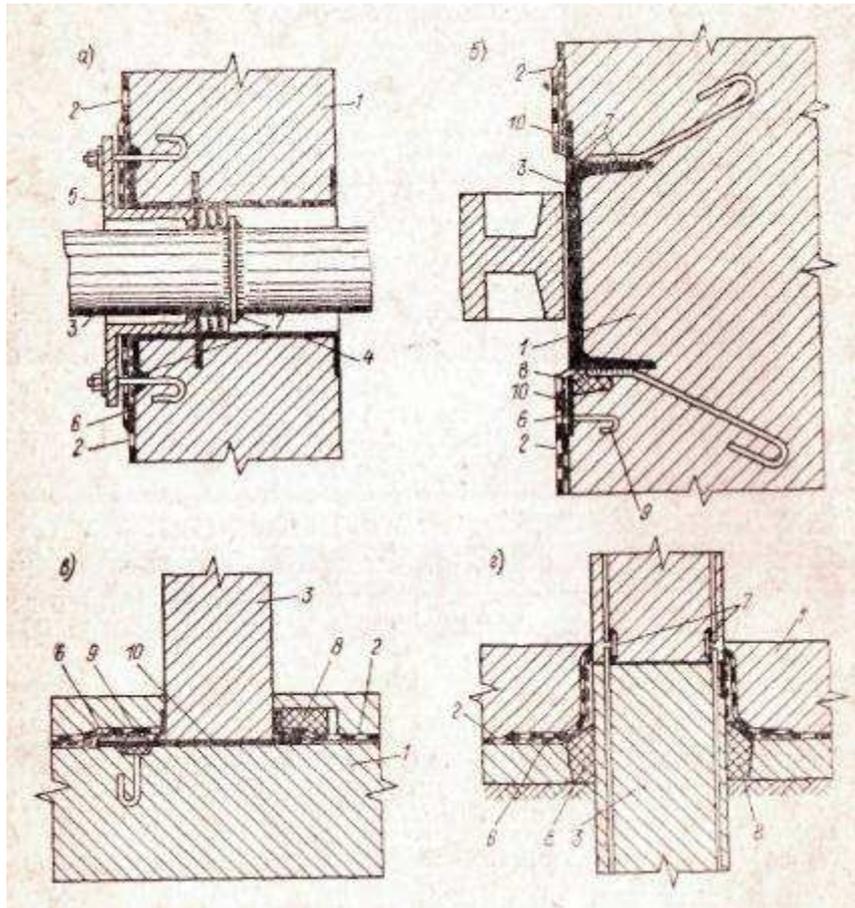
Сопряжения гидроизоляционного покрытия с деформируемыми деталями (к п. 2.29)
